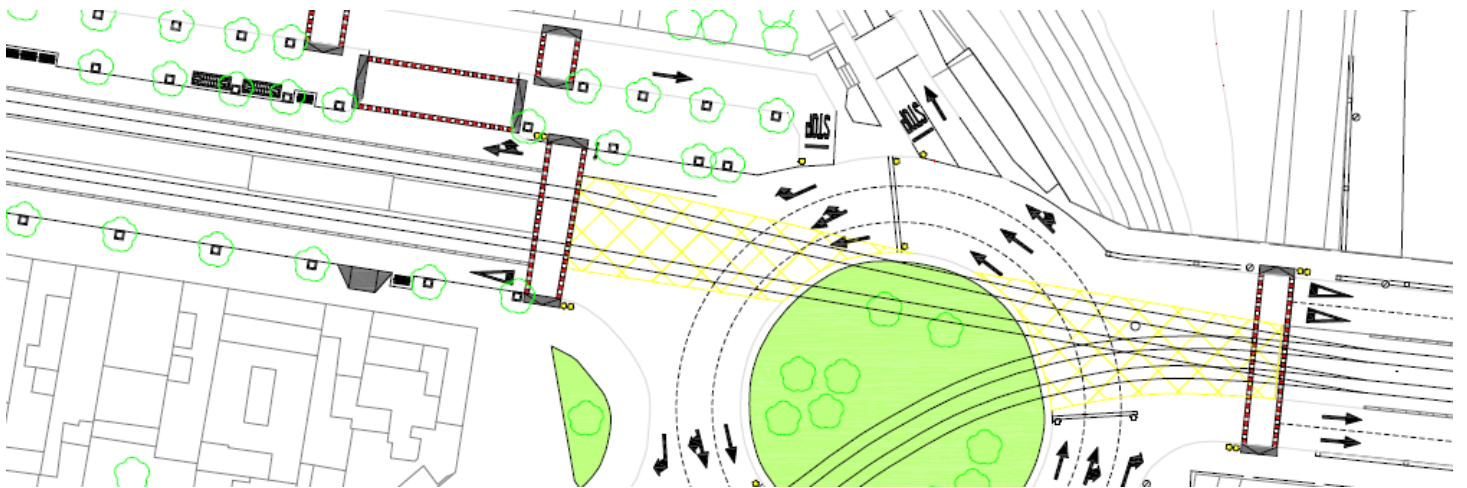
Vista en planta de Laureà Miró con Avenida de Cornellà. Continuación en vía doble hasta la Plaza Santa Magdalena.
